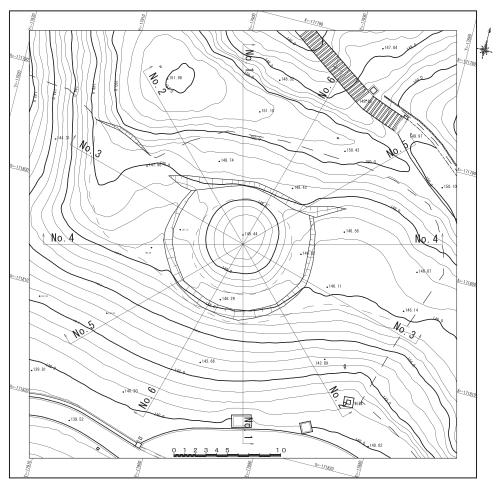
墳丘竣工平面図(地形復元模型作成範囲と一致)および断面位置図
